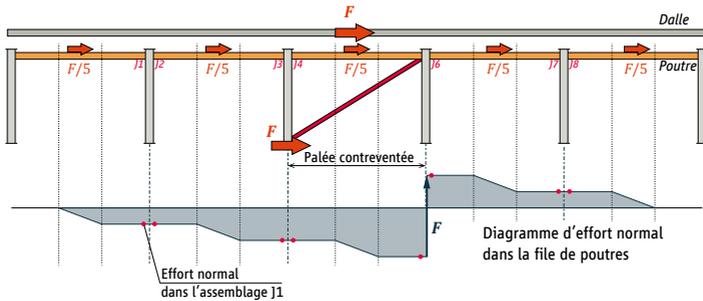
Transfert des efforts le long des poutres d'un plan de contreventement
